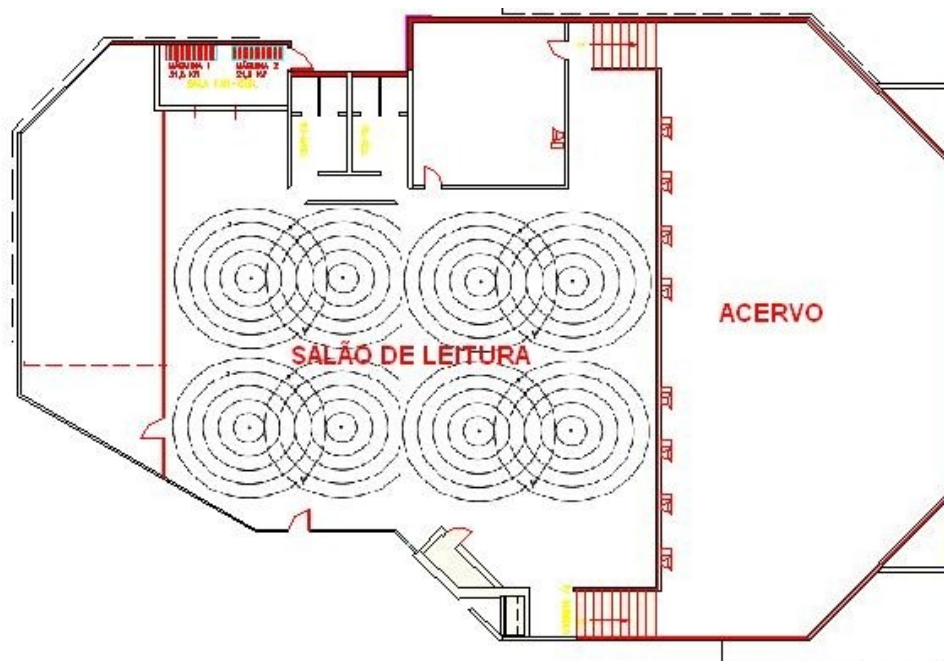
Planta da Biblioteca do IFMA (Salão de leitura em destaque)
